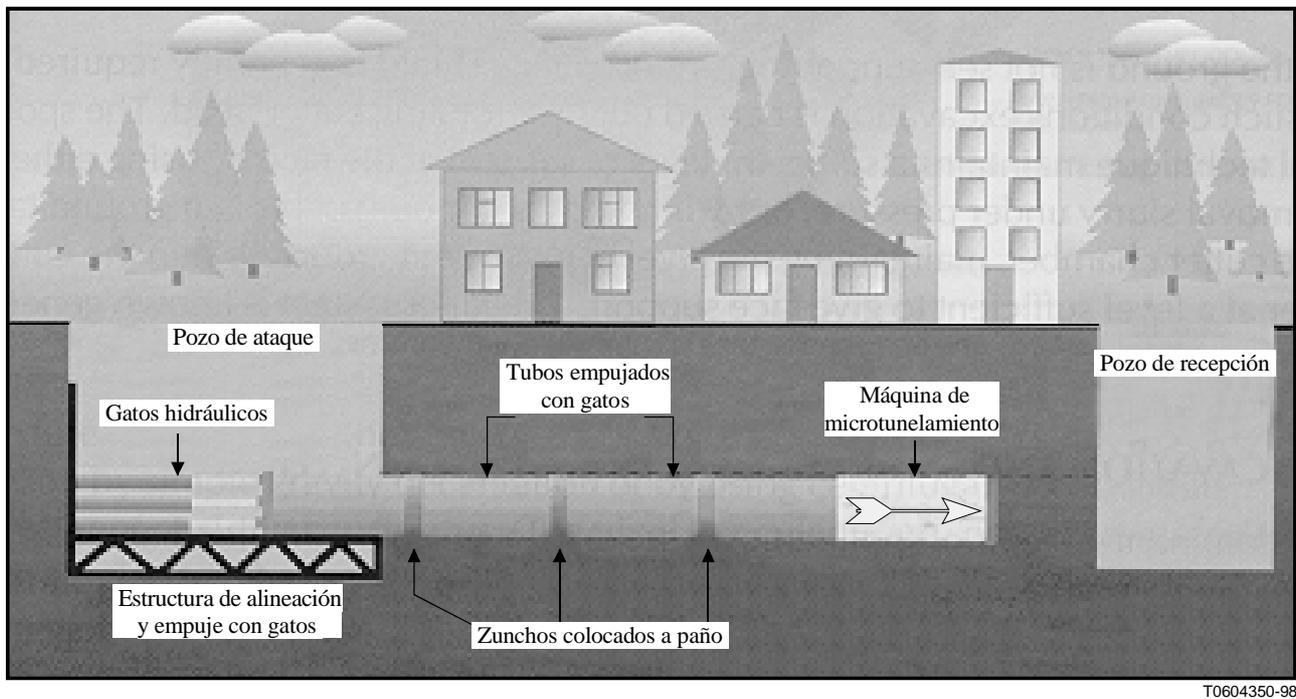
/L.38 – Instalación de tuberías por microtunelamiento
